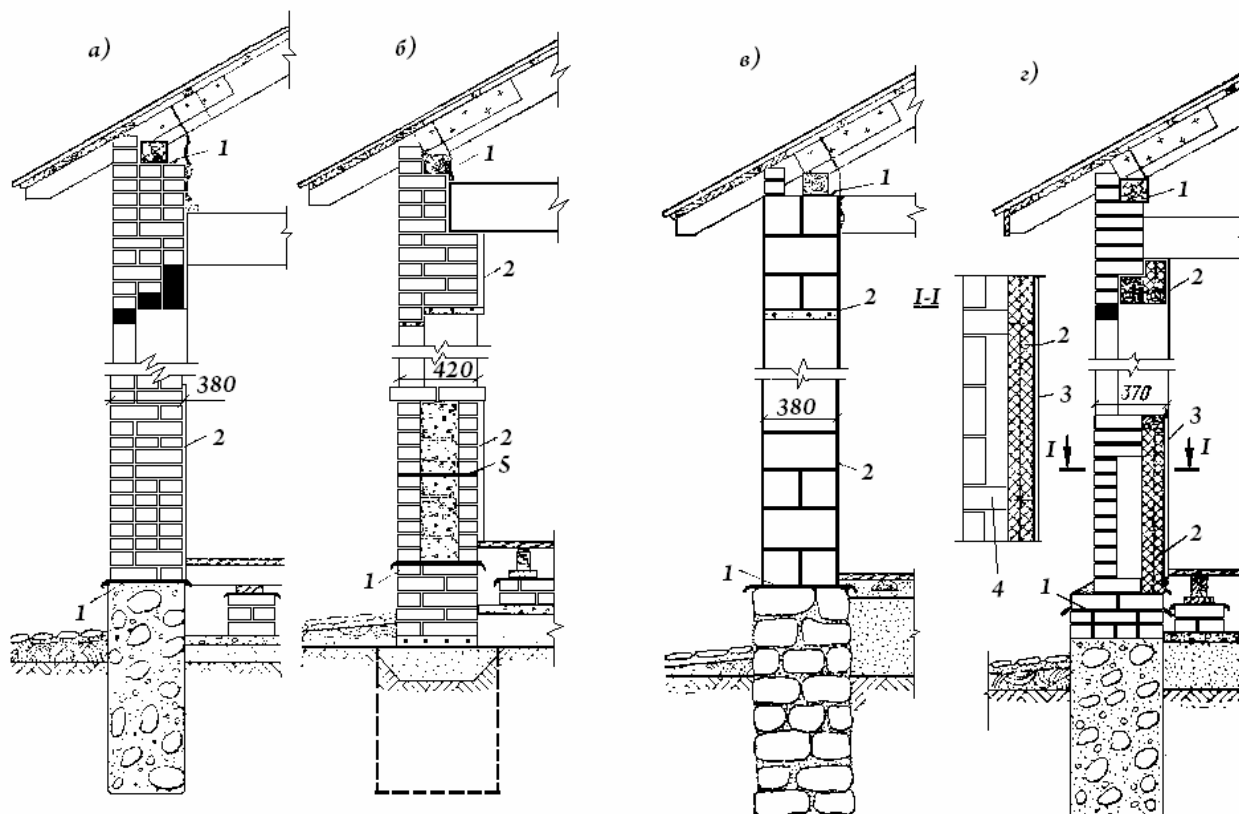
Разрезы наружных несущих стен малоэтажных каменных зданий:
